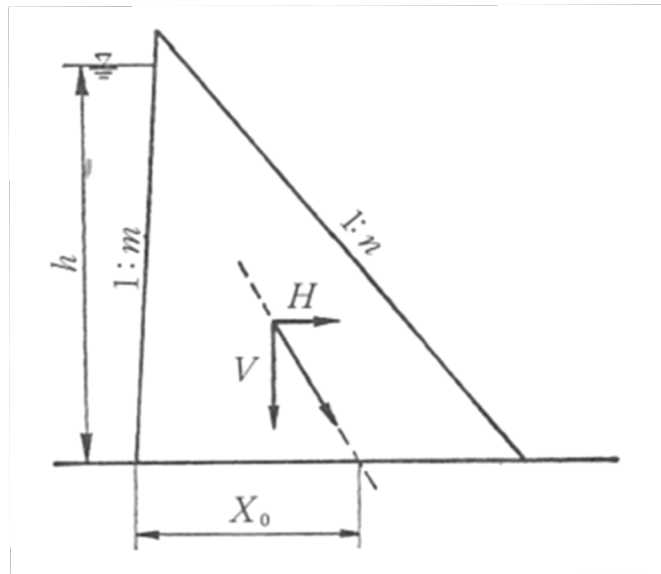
重力式コンクリートダムに作用する合力の作用点
